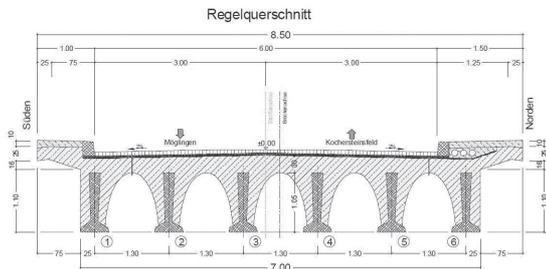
Brückenquerschnitt mit einbetonierten Spannbeton-Fertigteilträgern aus Tonerdeschmelzzement
